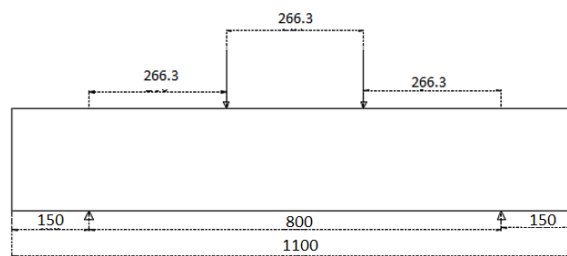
Vigas sem armadura transversal, dimensões em mm (Sathiyamoorthy, 2016).
